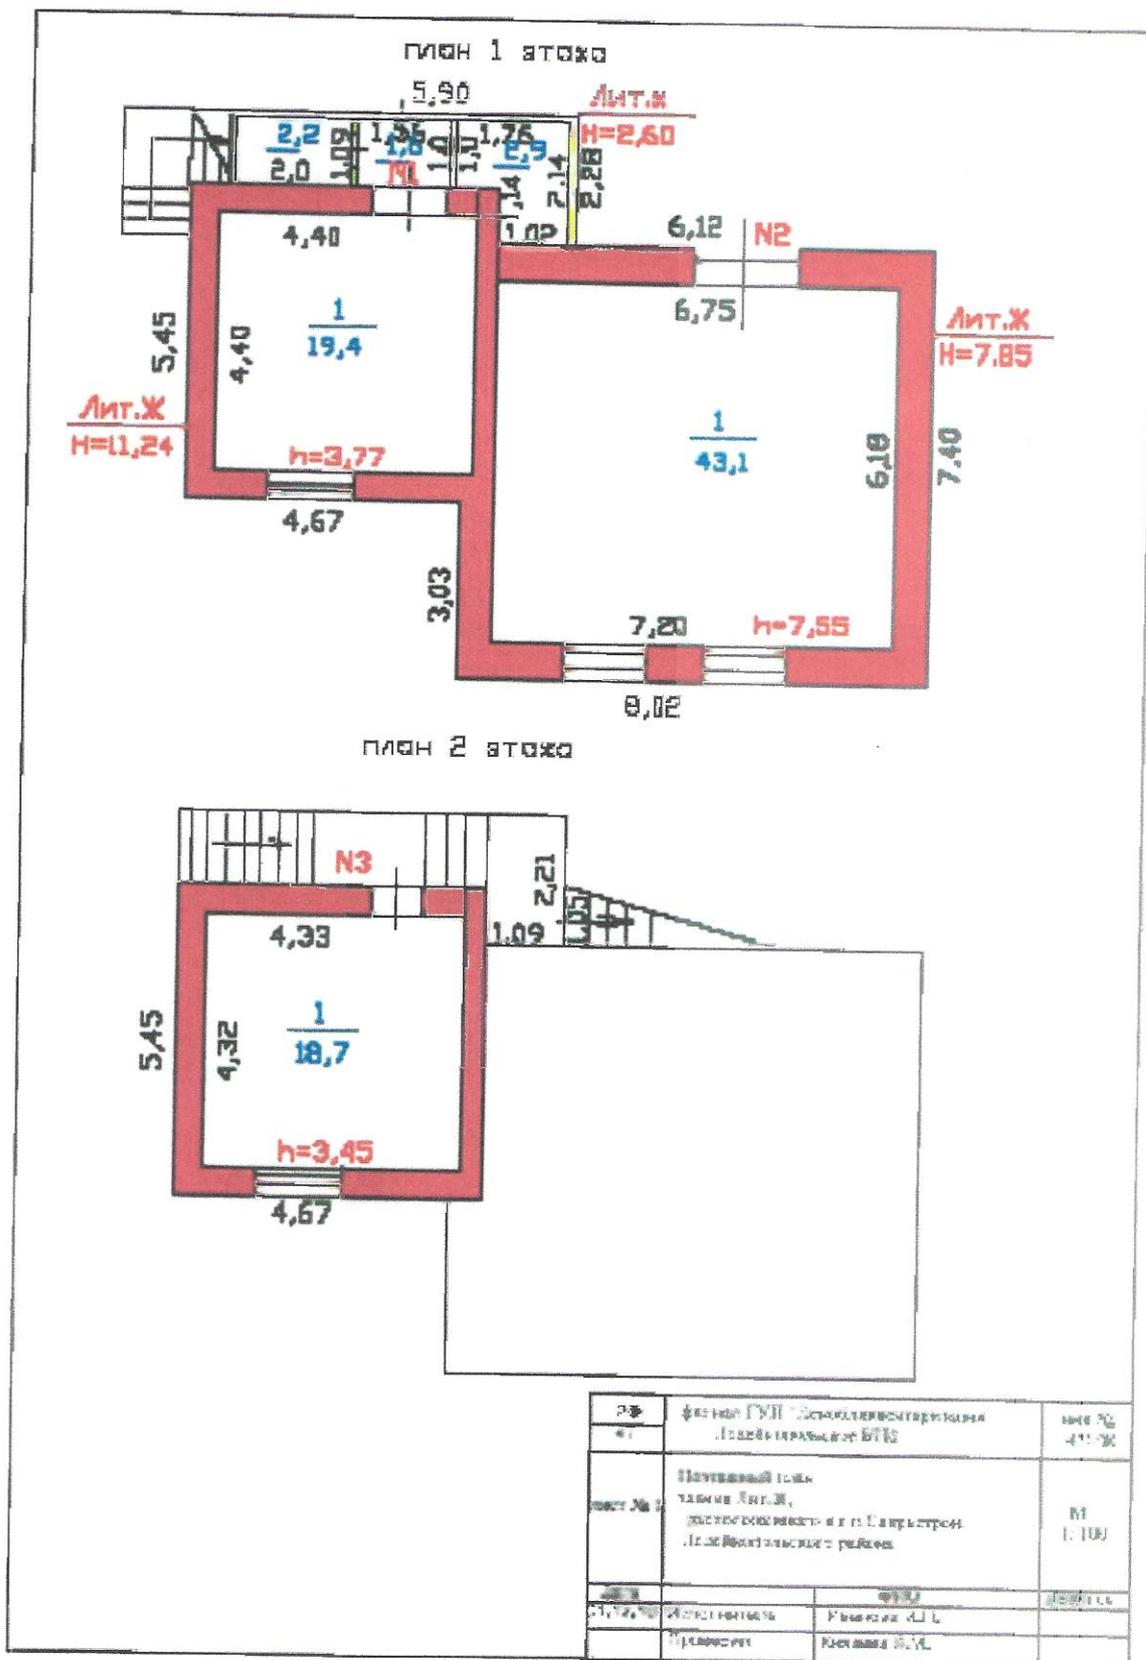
поэтажный план здания Лит. Ж (1 и 2 этажи)
